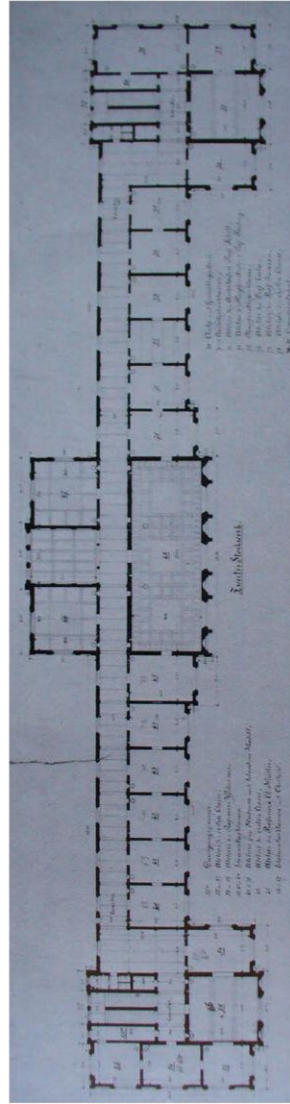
Grundriss des zweiten Stocks des Düsseldorfer Kunstakademiegebäudes 1879: A = Gemäldegalerie und Aula.
